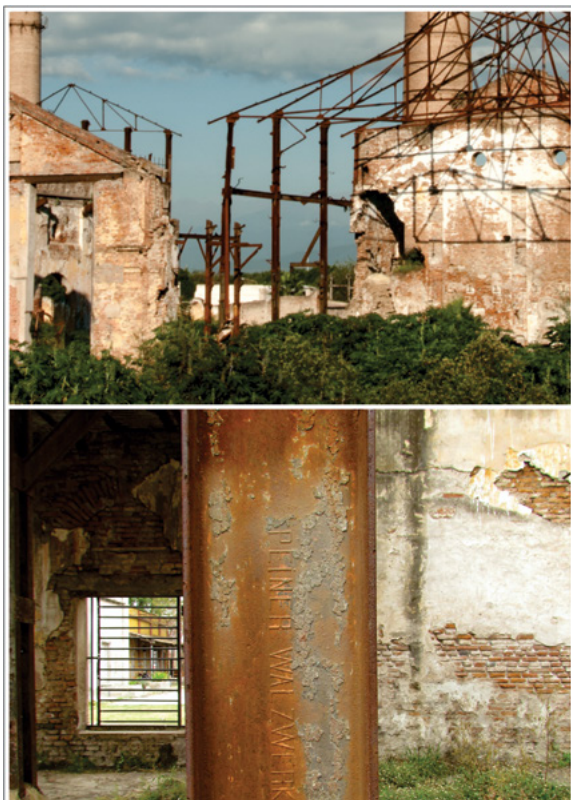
Arriba: Sistema de entramado de perfiles metálicos, técnica constructiva utilizada en un grupo de edificios del ingenio. Abajo: Detalle de la firma “Peiner Walzwerk”, fabricante de los perfiles empleados en el entramado.
